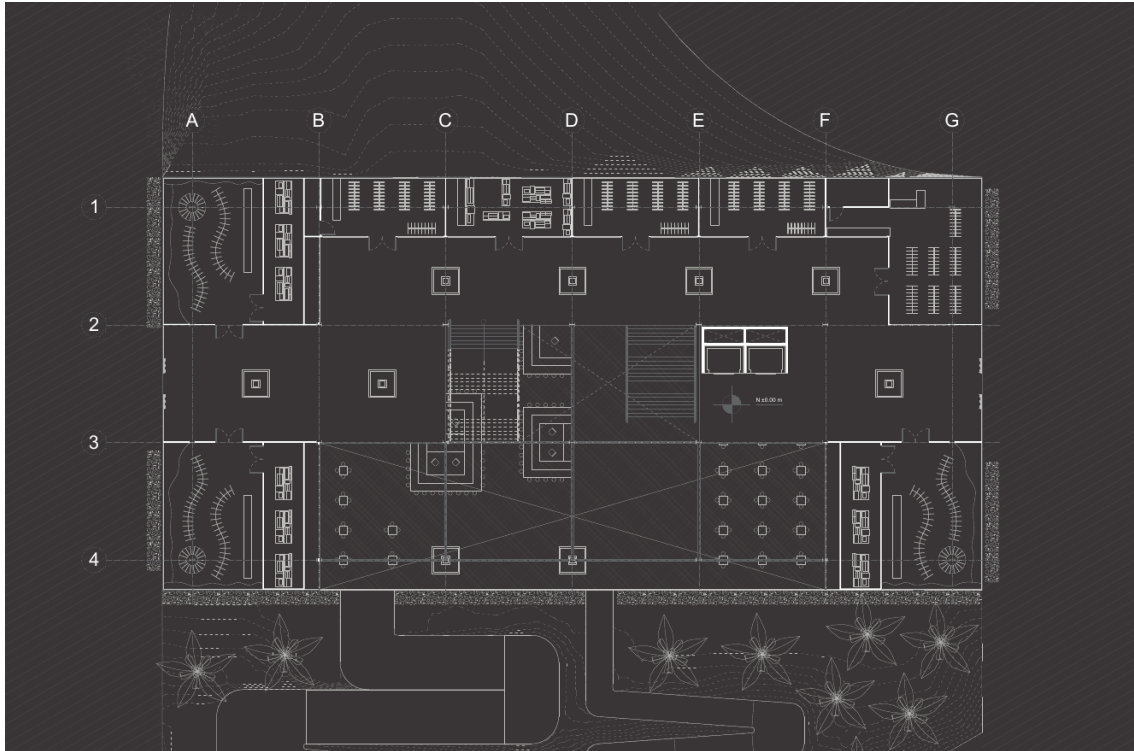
Planta nivel ± 0.00 , Fuente: Elaboración propia
